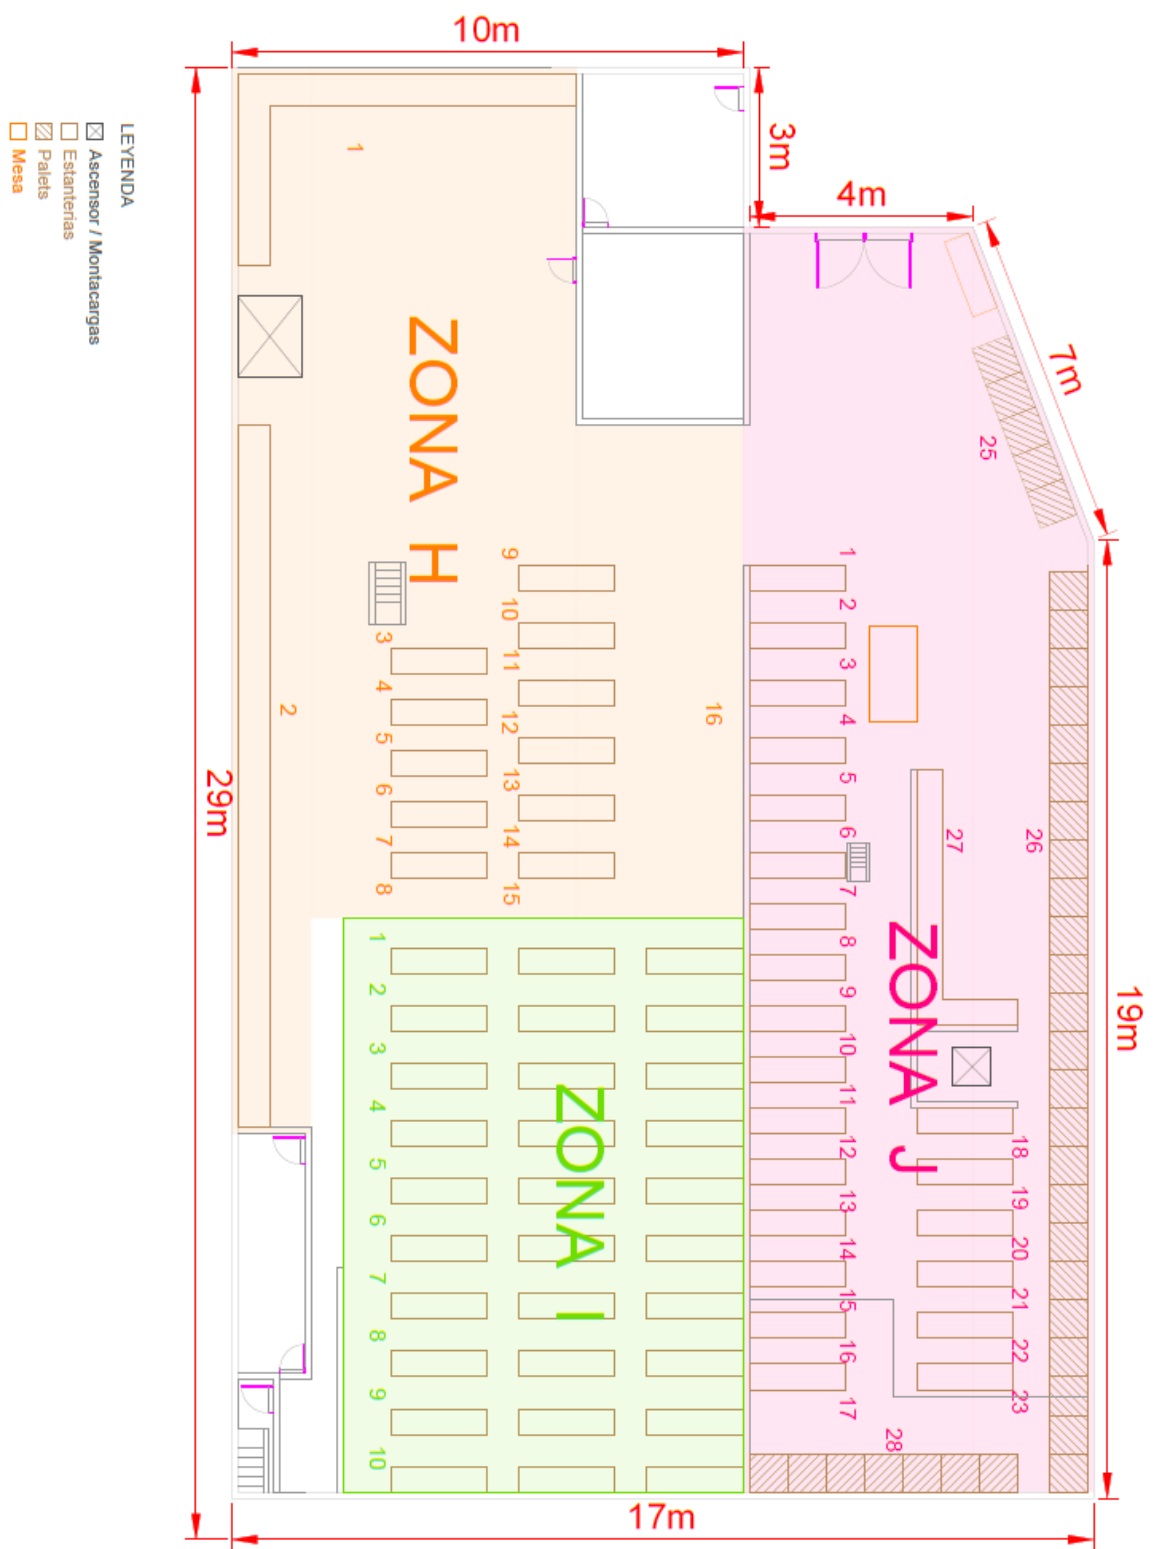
Imagen del plano de la segunda planta por zonas (Anexo D: P006)
